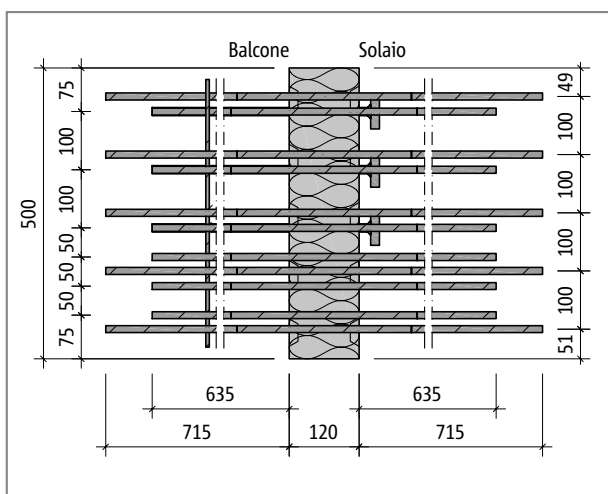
Schöck Isokorb® tipo EXT50-R-V12: pianta del prodotto
